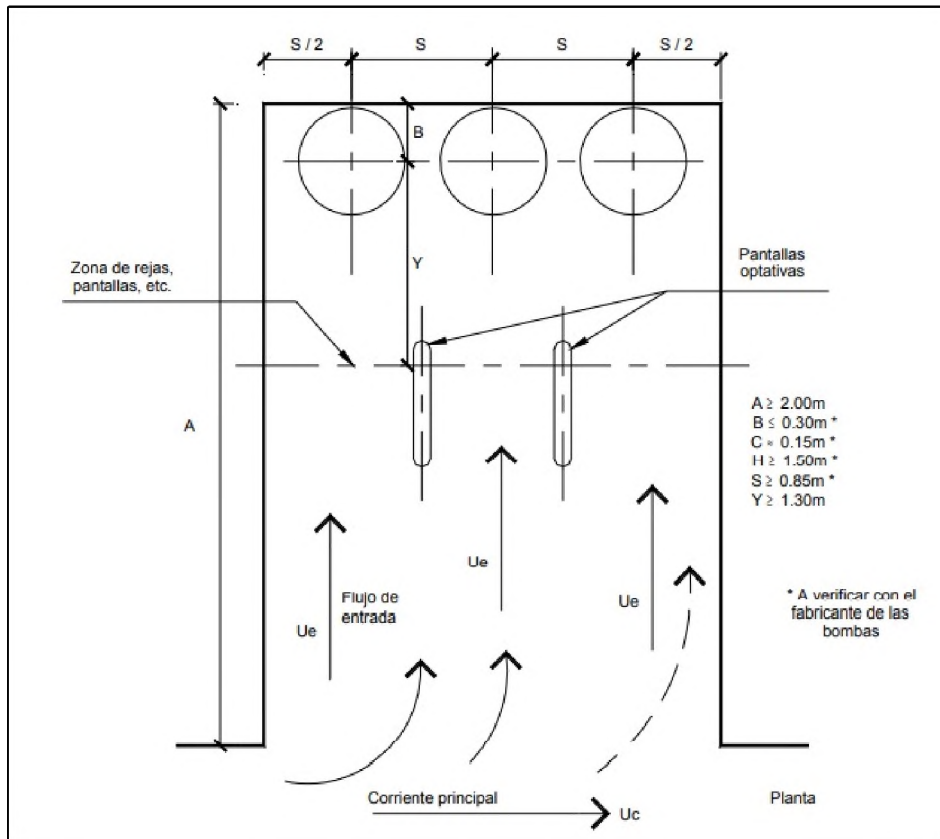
Vista en planta recomendado para cámaras de aspiración (Fuente: Estaciones de bombeo de Agua cruda y tratada de la Enhosa)
